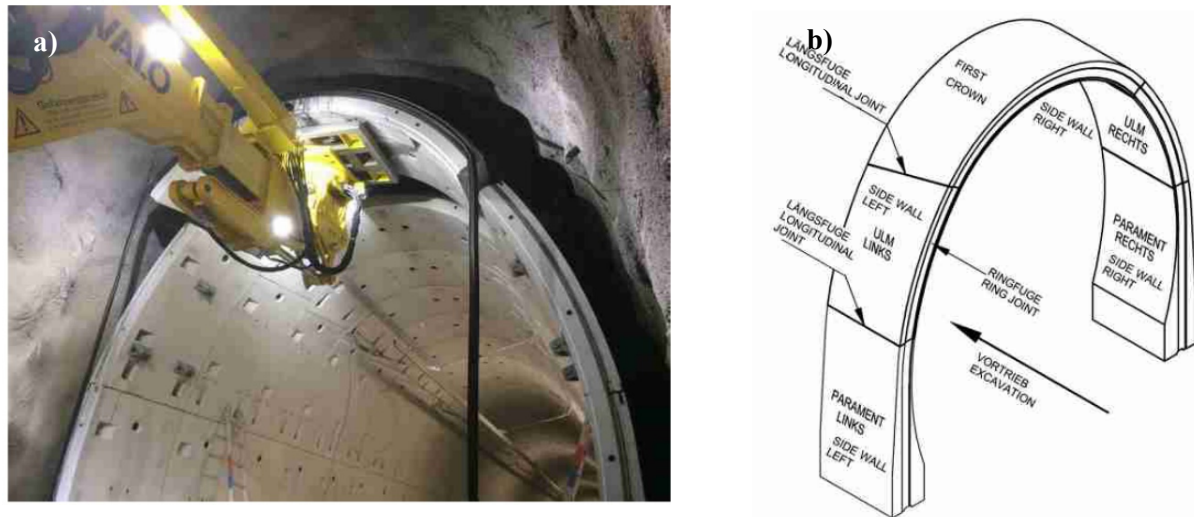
a) Einbau des Firststeines mit Ringdichtung [43]. b) Aufbau der Betonfertigteile. Plangrundlagen Normalbauweise-Amberg Engineering [12].
